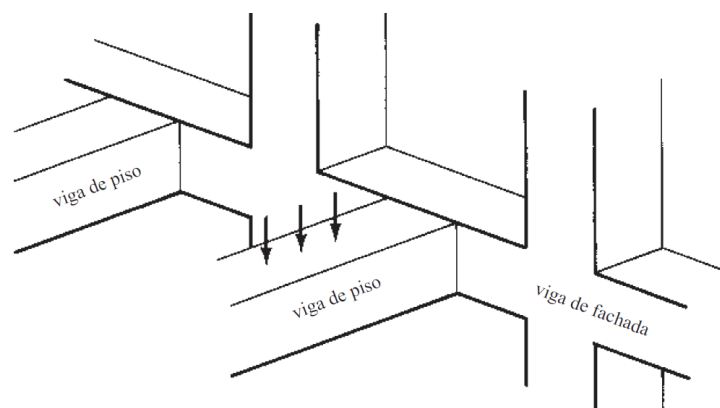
Torsión en vigas de fachada (McCormac y Brown, 2018)
